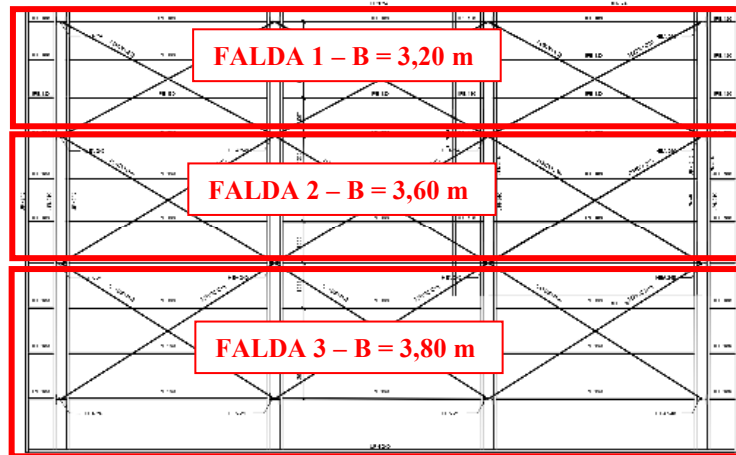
Planimetria con particolare orditura di copertura e individuazione falde
